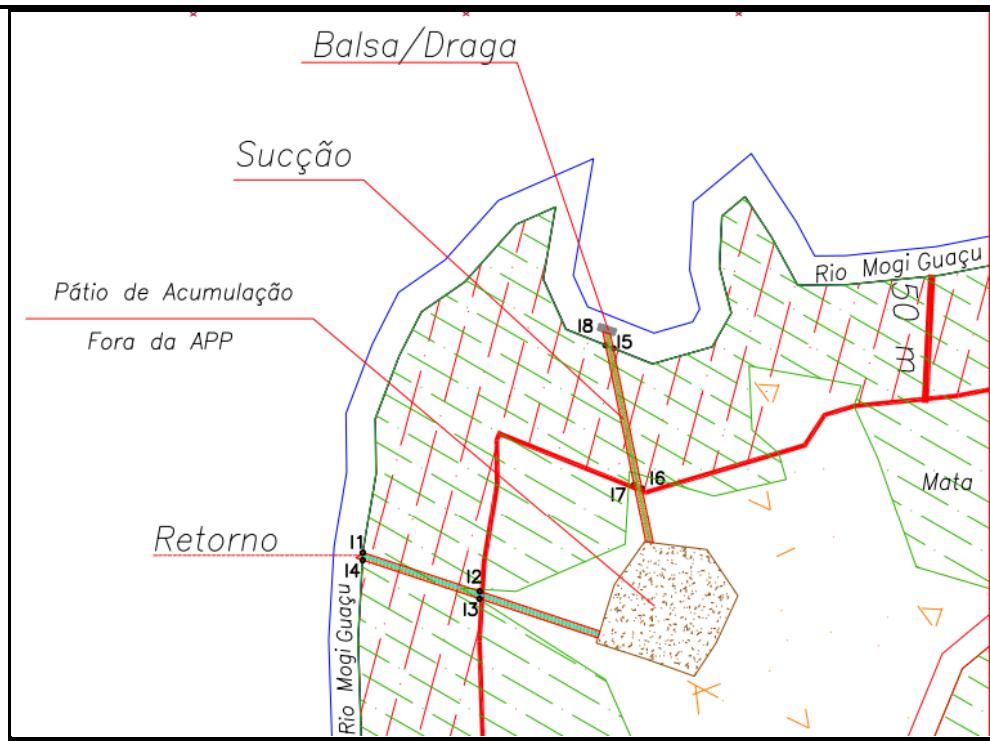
Planta com o pátio e as tubulações de sucção e retorno. Fonte: SLA.
